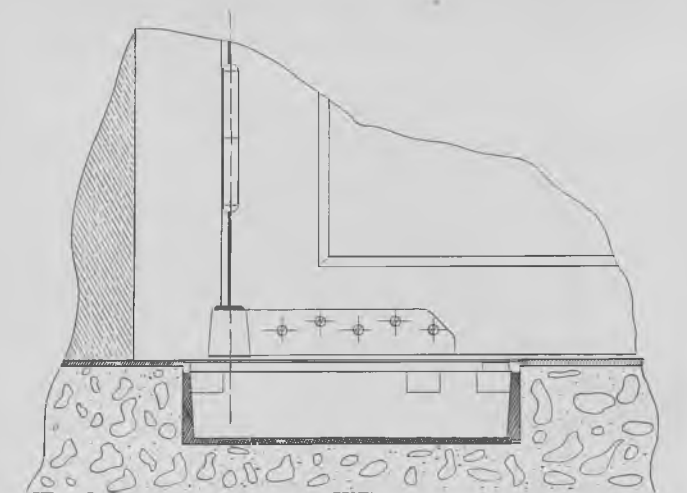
Gulvdørlukker, model C, venstre monteret på hængslet dør. Gulvdørlukkeren faststøbt i betongulv. (N & L.)
